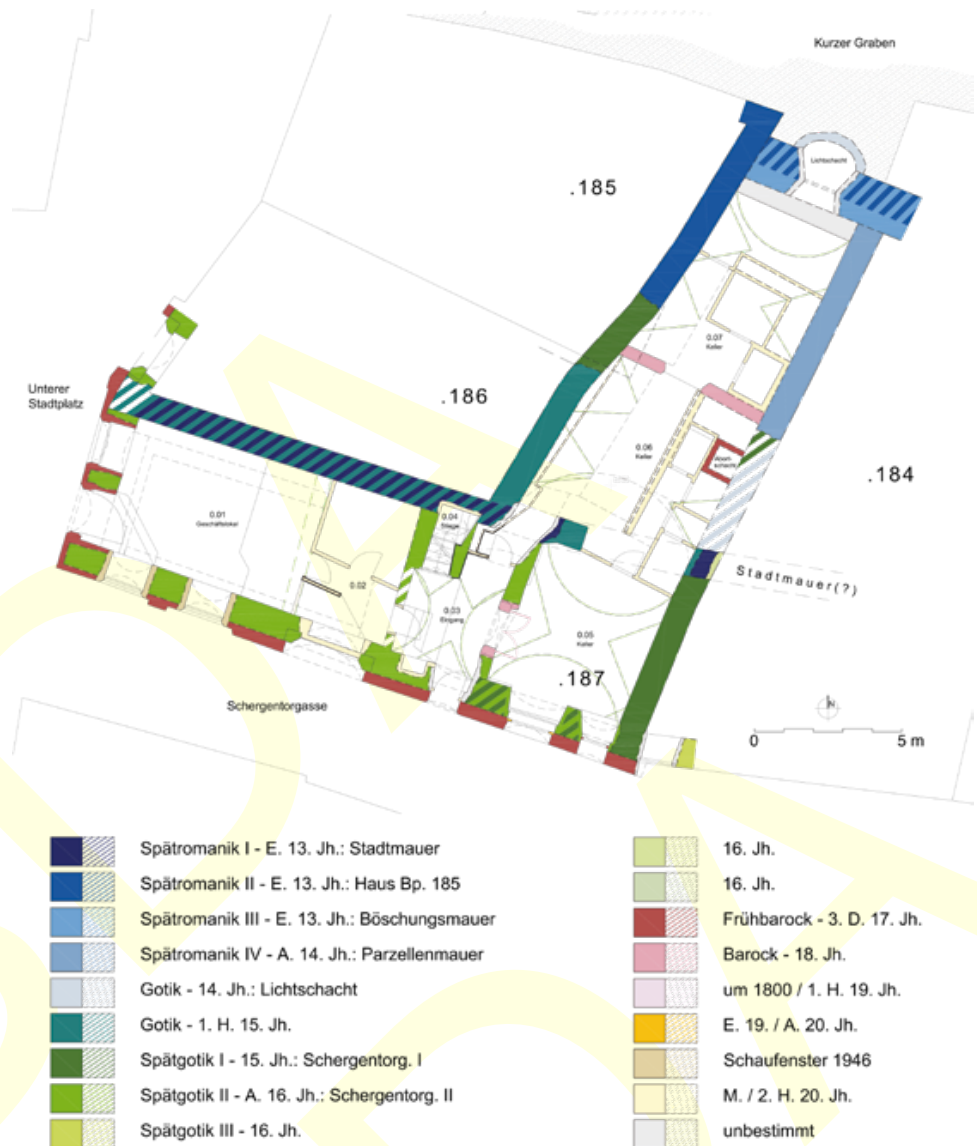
Hall, Köglerhaus. Baualterplan des Erdgeschosses.
